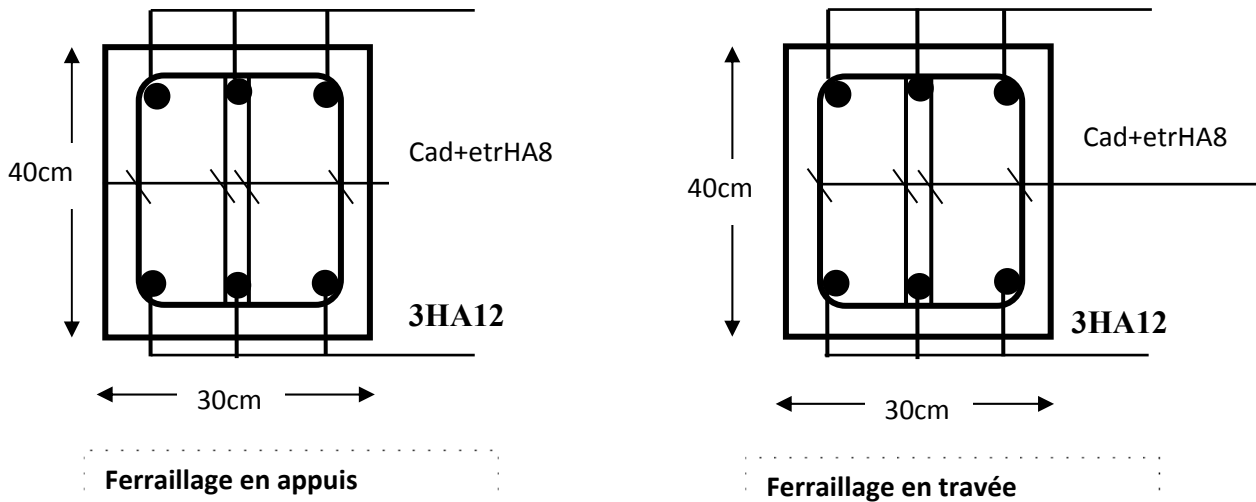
Schéma de ferrailage de la poutre palière du 3^{ème} Type d'escalier.
